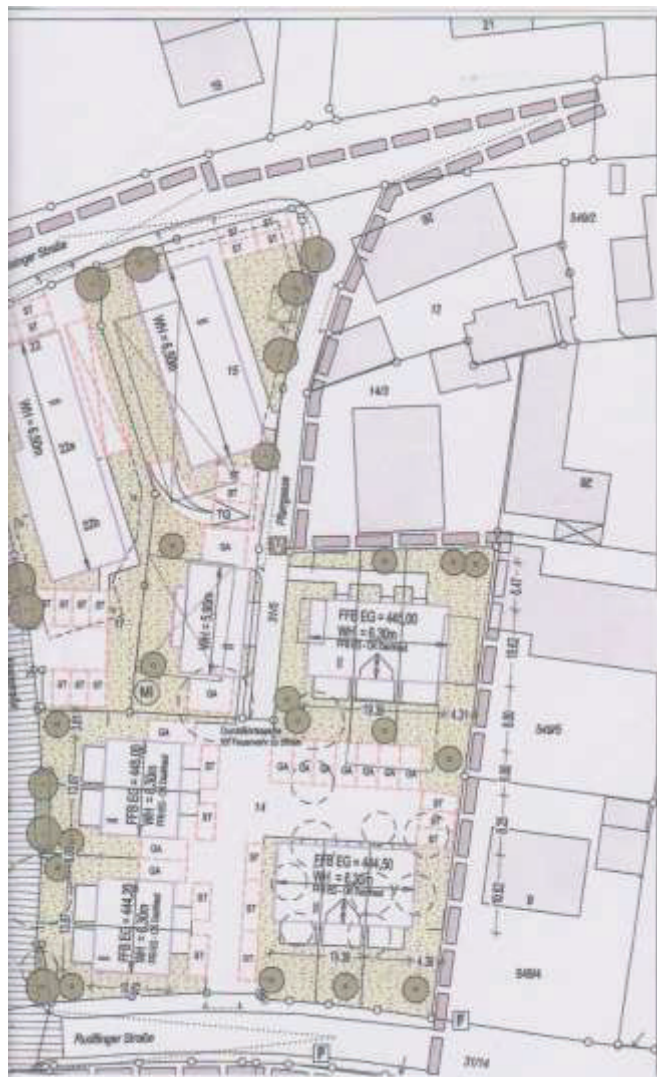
Ausschnitt des geänderten Bebauungsplans Kirchstraße/ Rudlfinger Straße
